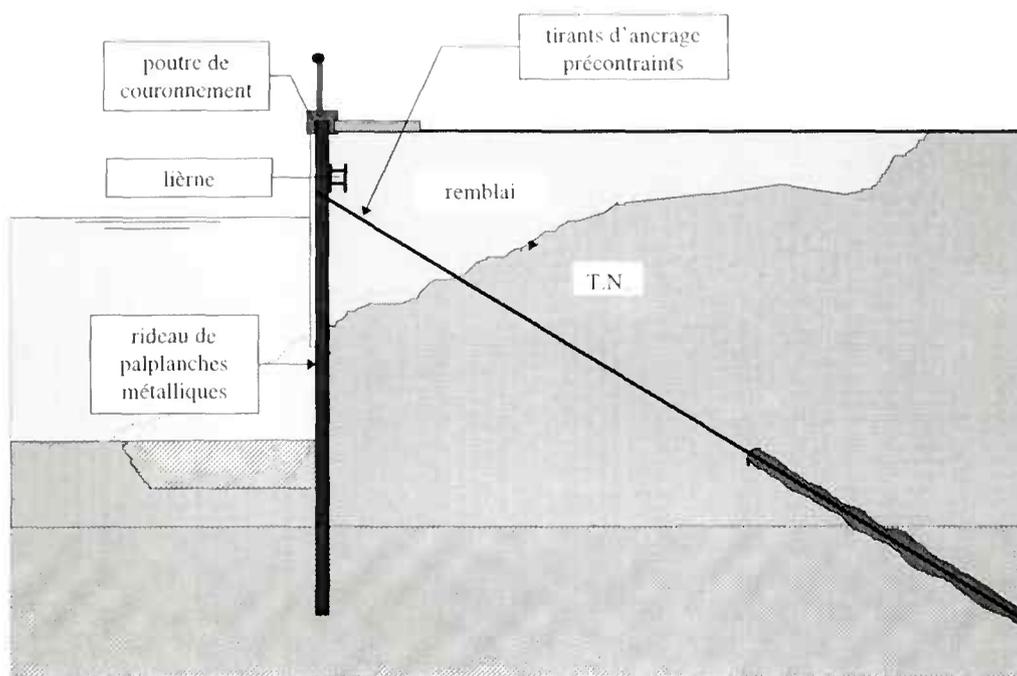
Exemple de constitution d'un soutènement de rive en palplanches
